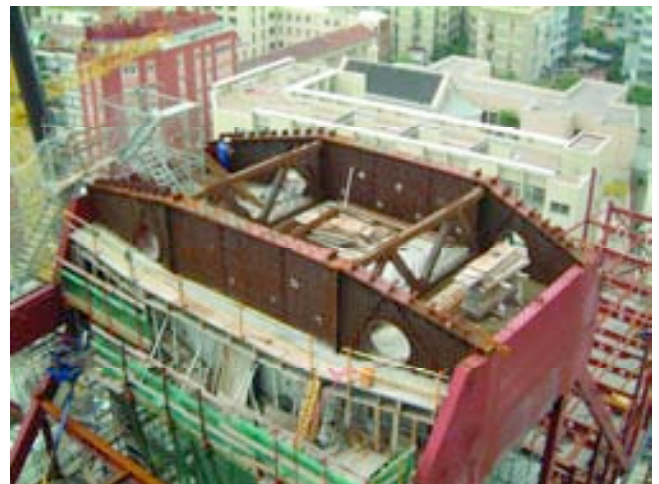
Posicionamiento de las piezas metálicas del elemento de suspensión.
